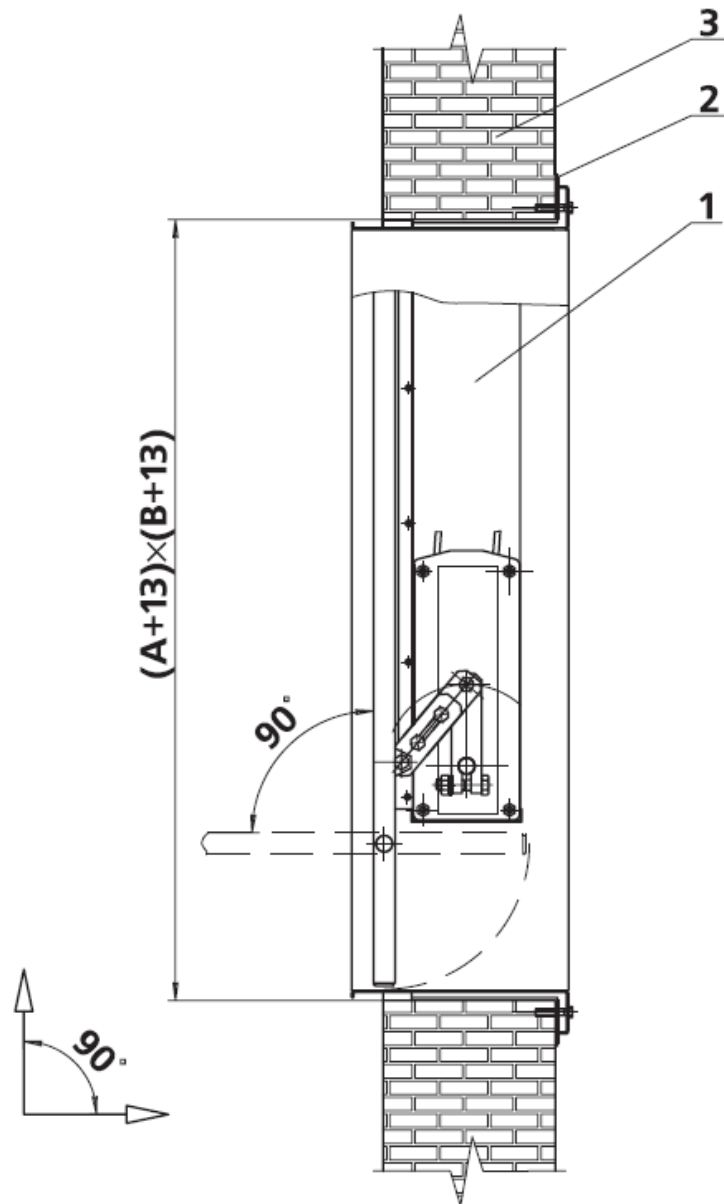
Монтаж дымового клапана КПД-4 производства ООО «Веза», присоединяемого к стене с использованием монтажной рамы: 1 – клапан; 2 – монтажная рама (мрз); 3 – стена
